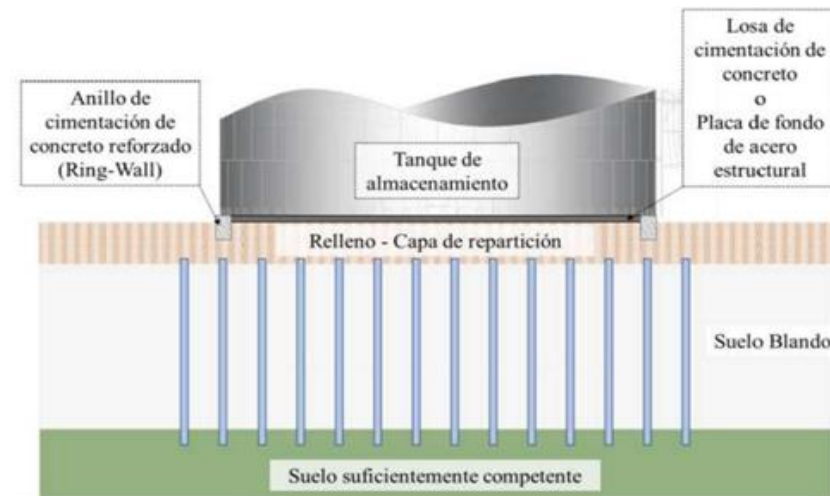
Columnas de grava en cimentación de un tanque de almacenamiento.
